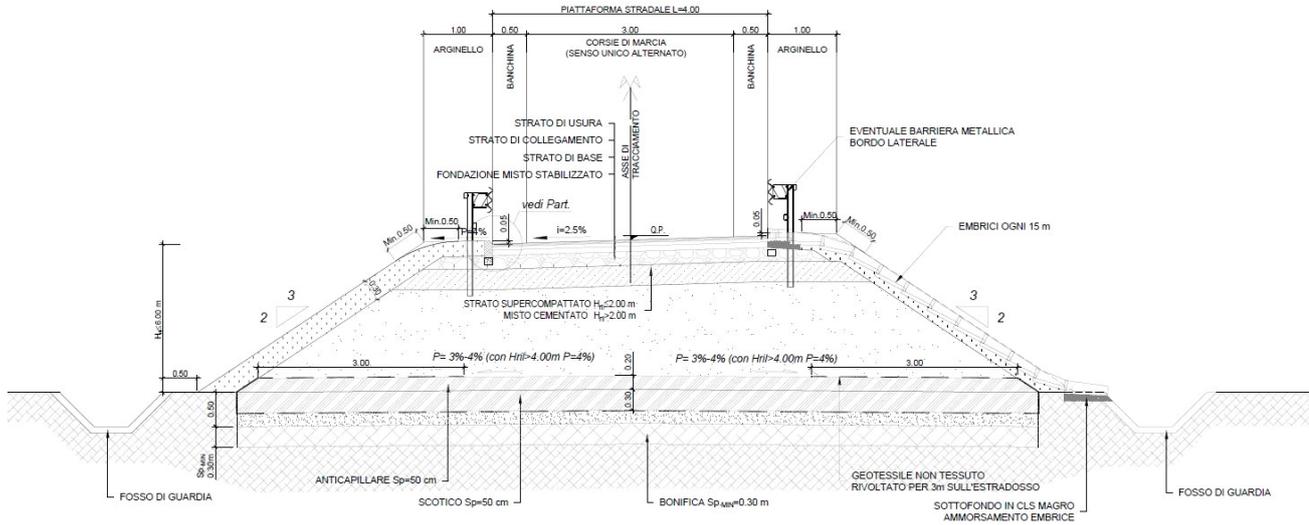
Dest. Particolare 4.0 m – sezione tipo in rilevato $H_{ril} \leq 6.00$ m
